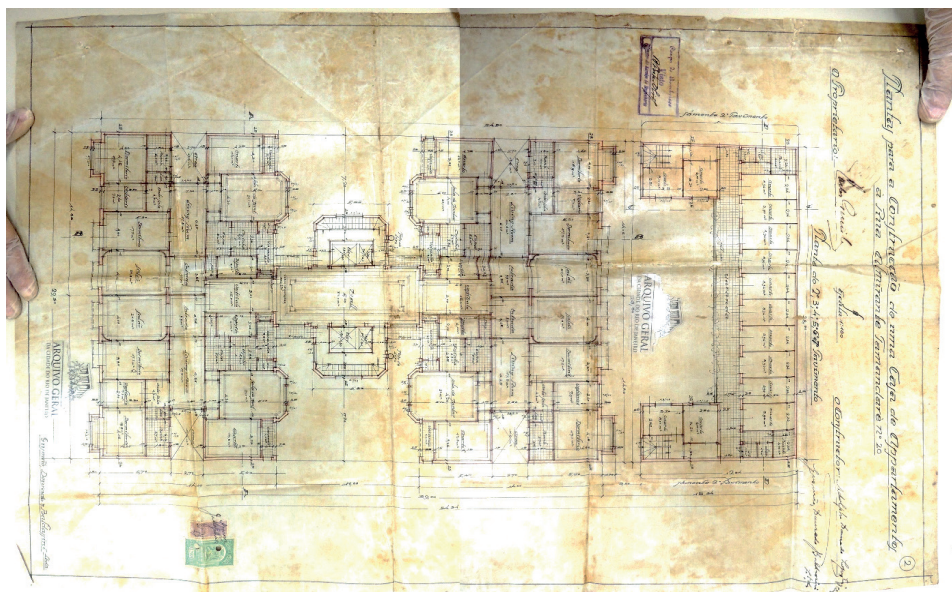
Planta baixa do pavimento tipo com edícula do ed. Tamandaré
